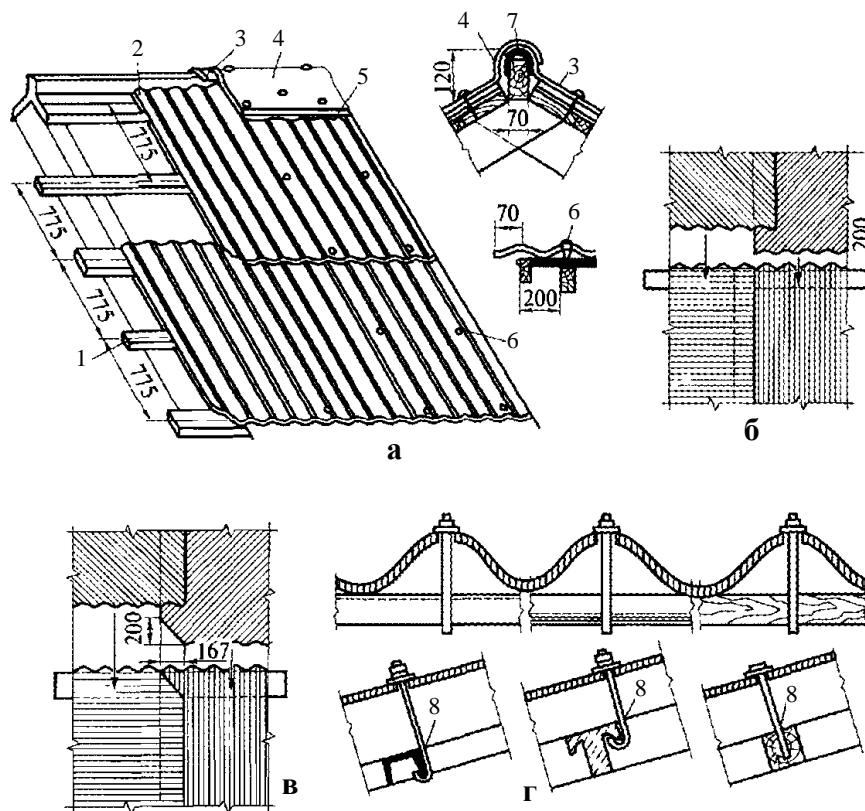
Схема влаштування покрівлі з азбестоцементних листів: а – частина скату із поперечним розрізом гребеня та фронтону; б, в – укладання листів зі зміщенням і обрізанням кутів; г – варіанти кріплення листів до металевих, залізобетонних і дерев'яних прогонів; 1 – лати; 2 – лист; 3, 4 – гребеневі азбестоцементні листи; 5 – обмазка мастикою; 6 – покрівельні цвяхи; 7 – гідроізоляційна стрічка; 8 – гак
